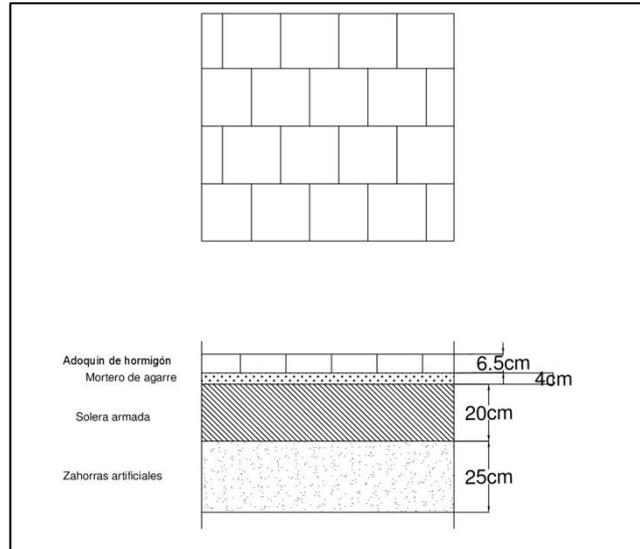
Sección tipo 1 pavimento adoquines de hormigón
